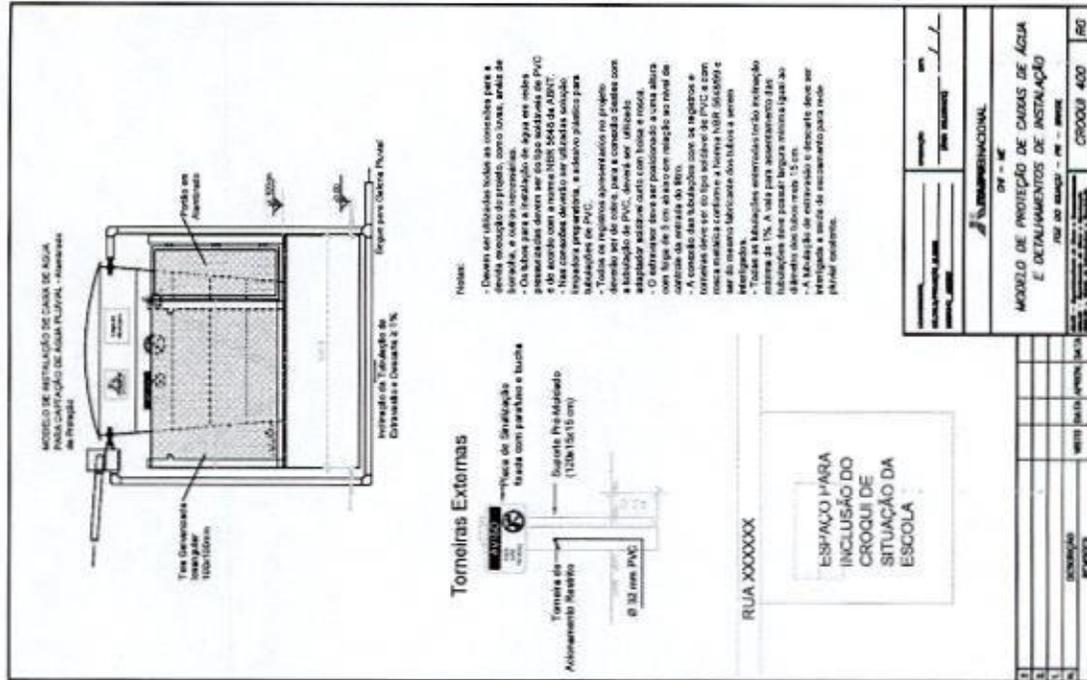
Modelo de referência do isolamento e detalhamento de instalação
